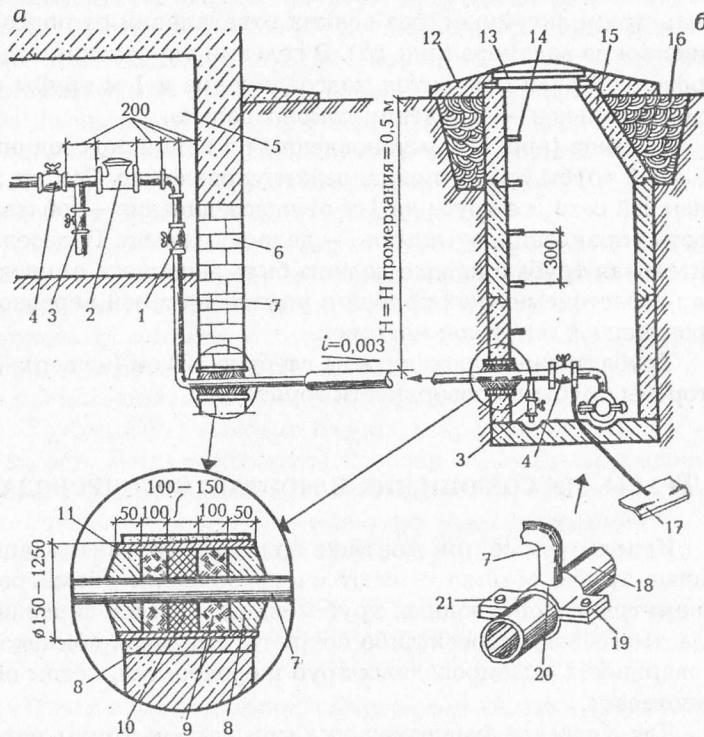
Устройство водопроводного ввода (а — ввод через фундамент, б — водозаборный колодец):
